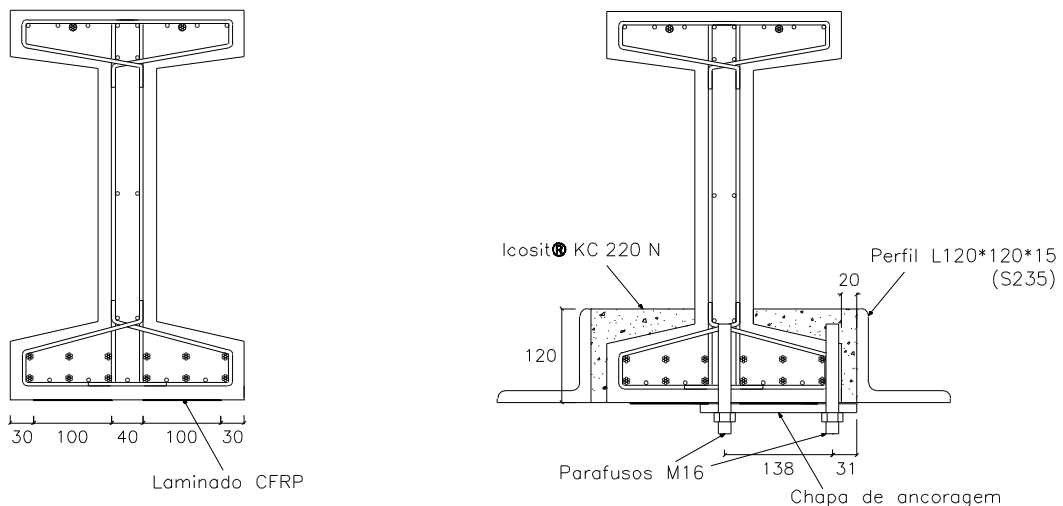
Secção transversal a meio-vão (esq.) e junto aos apoios (dir.) das vigas reforçadas (dimensões em mm) [14].
